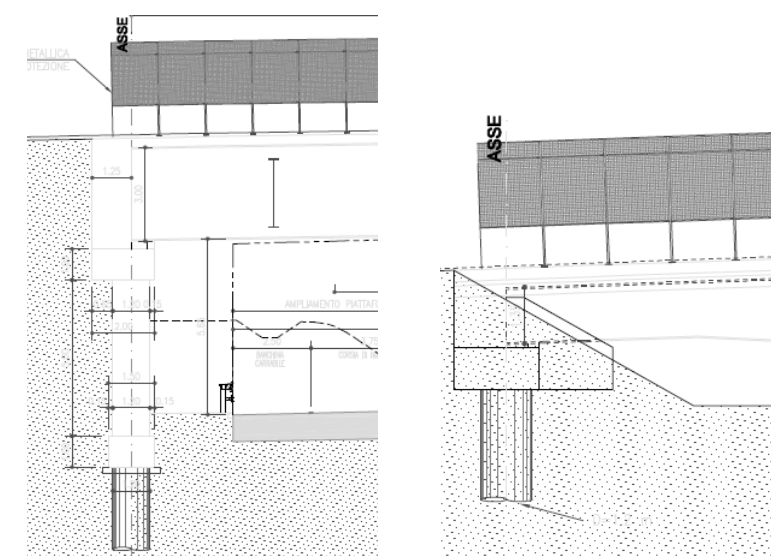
Spalle cavalcavia a una e a tre luci
